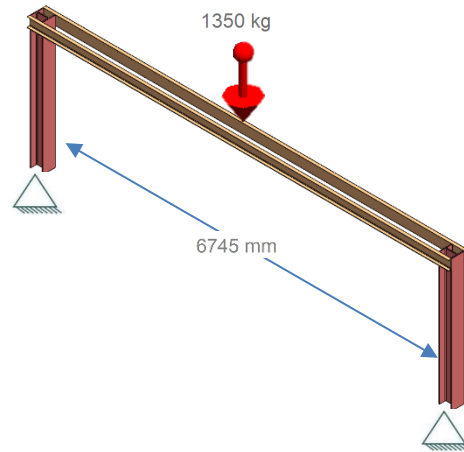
Modelo de la portería del horno. Resaltado en colores cálidos, perfiles HP8x36, de 2112[mm] de altura para postes y canal C6x8.2, de 6745 [mm] de largo para trabe.
